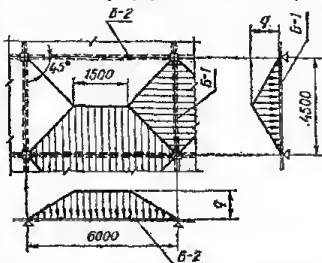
Схема распределения нагрузки на балки перекрытия с плитами, опирающимися по контуру.
